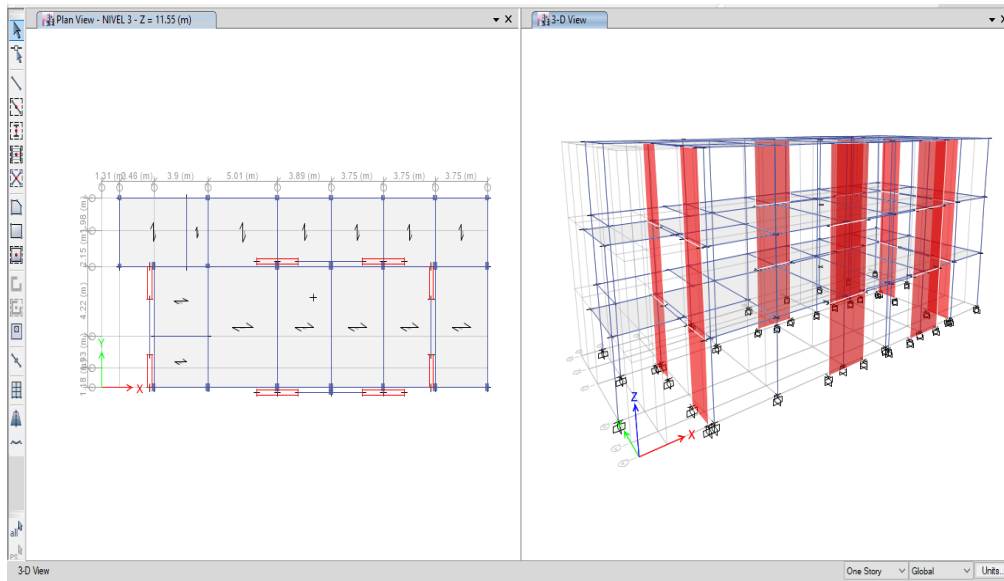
Vista en planta y modelo tridimensional en ETABS.
